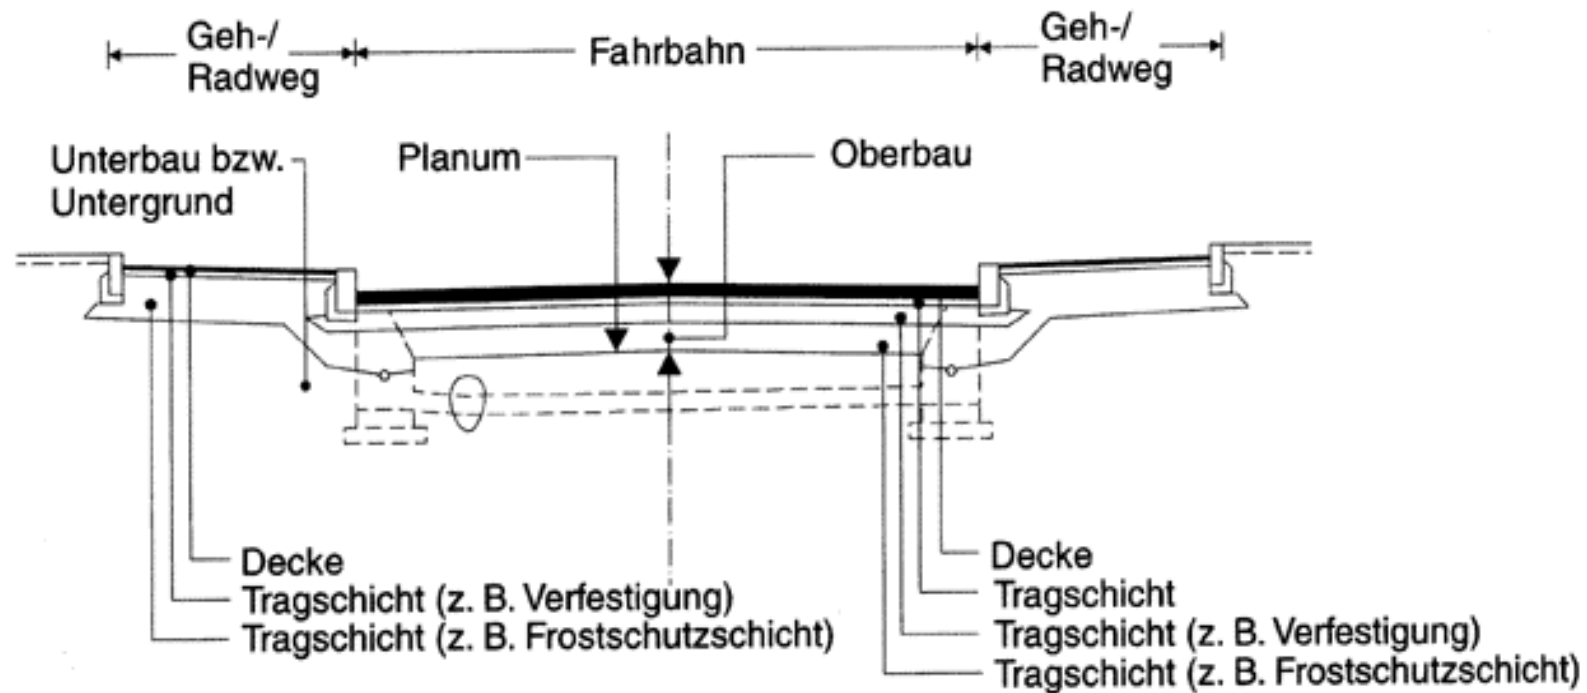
Beispielhafter Aufbau einer Befestigung in geschlossener Ortslage mit teilweise wasserundurchlässigen Randbereichen sowie mit Entwässerungseinrichtungen
